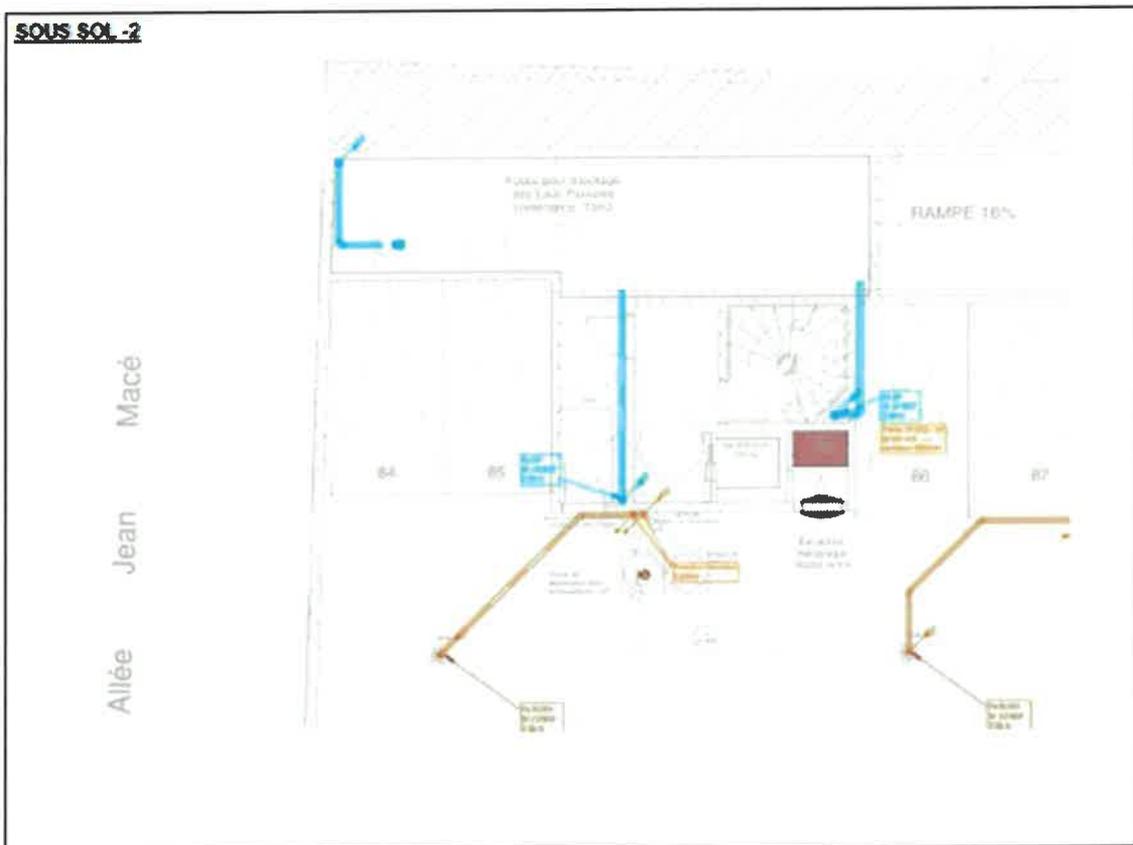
Plan de sous-sol & conception de l'ouvrage de rétention (Source : SOLAB Concept)
